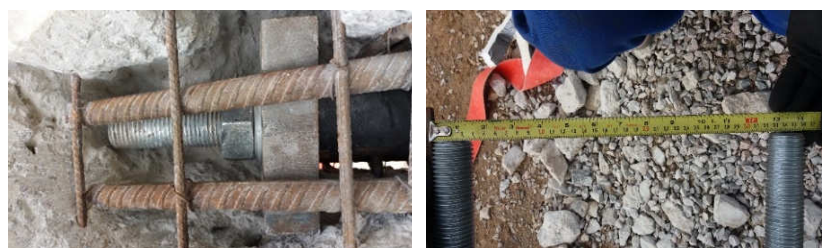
e 12 – Execução da hidrodemolição (Fonte: Dois A Tower System).
